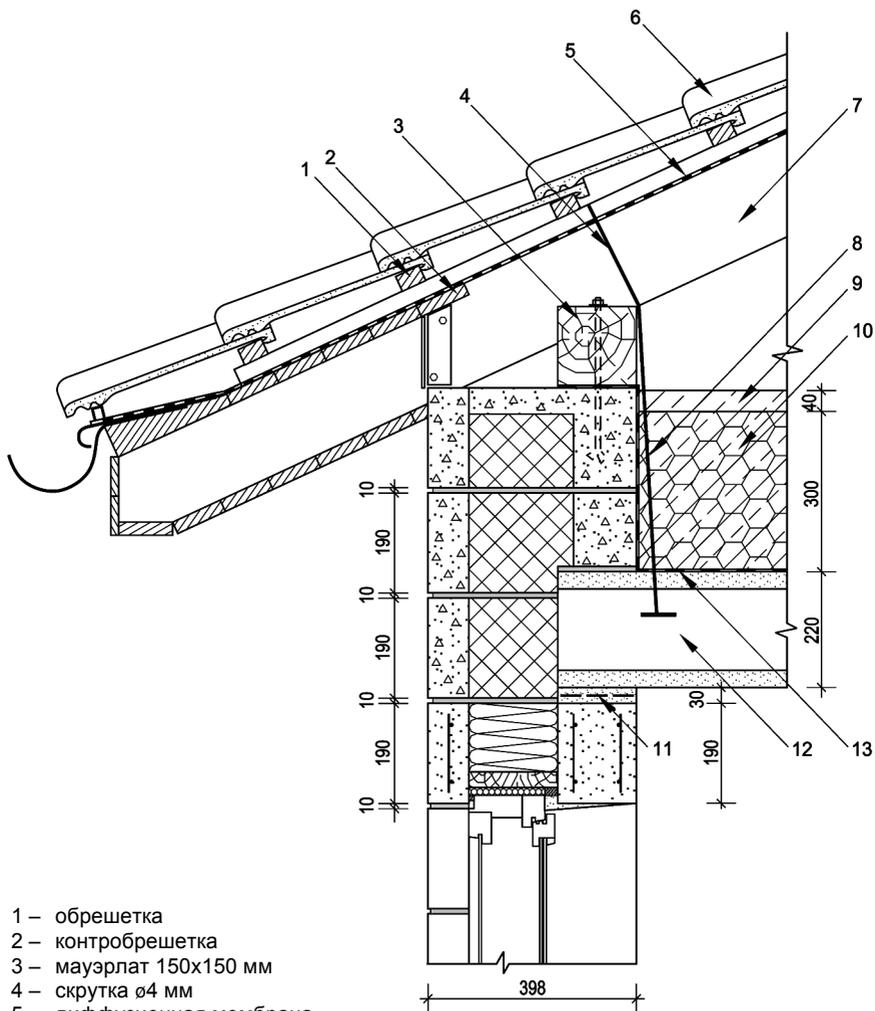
Схема кладки самонесущих наружных стен из трехслойных стеновых блоков
